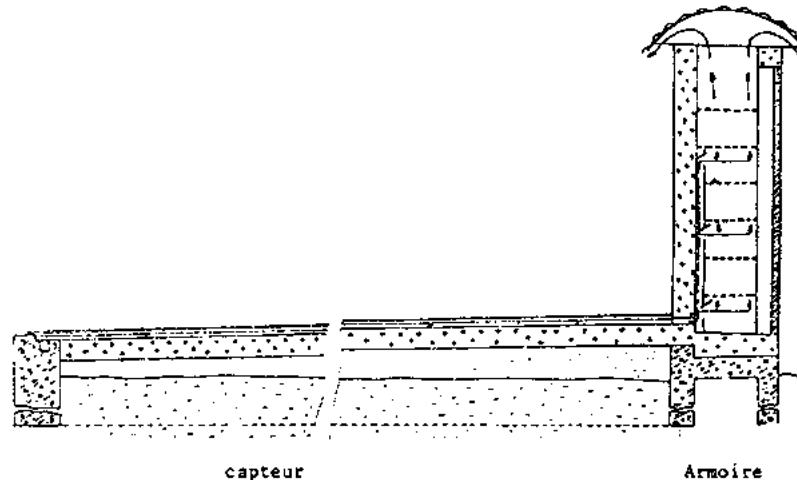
S \diamond choir indirect - Armoire a capteur plan (Coupe longitudinale)
